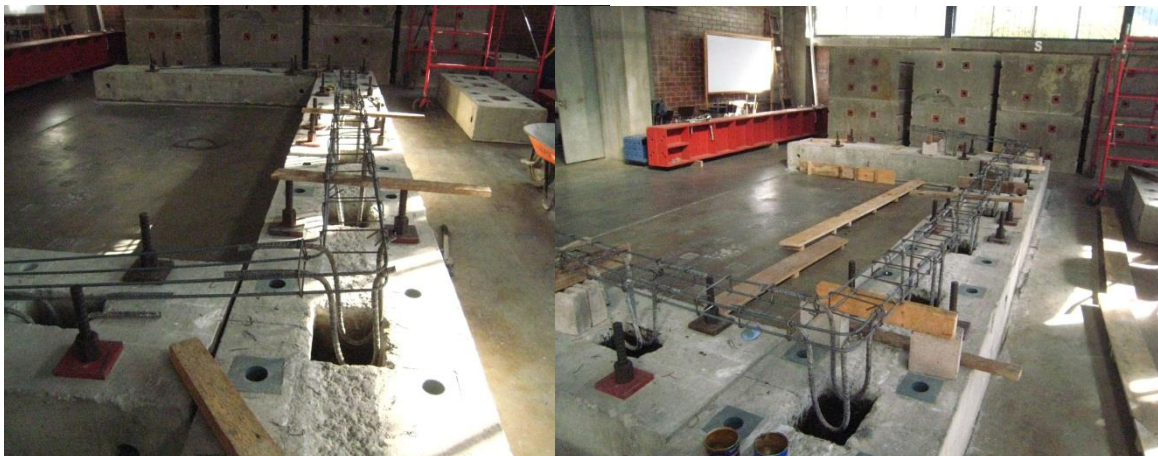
Colocación del refuerzo de la Solera de Fundación.
